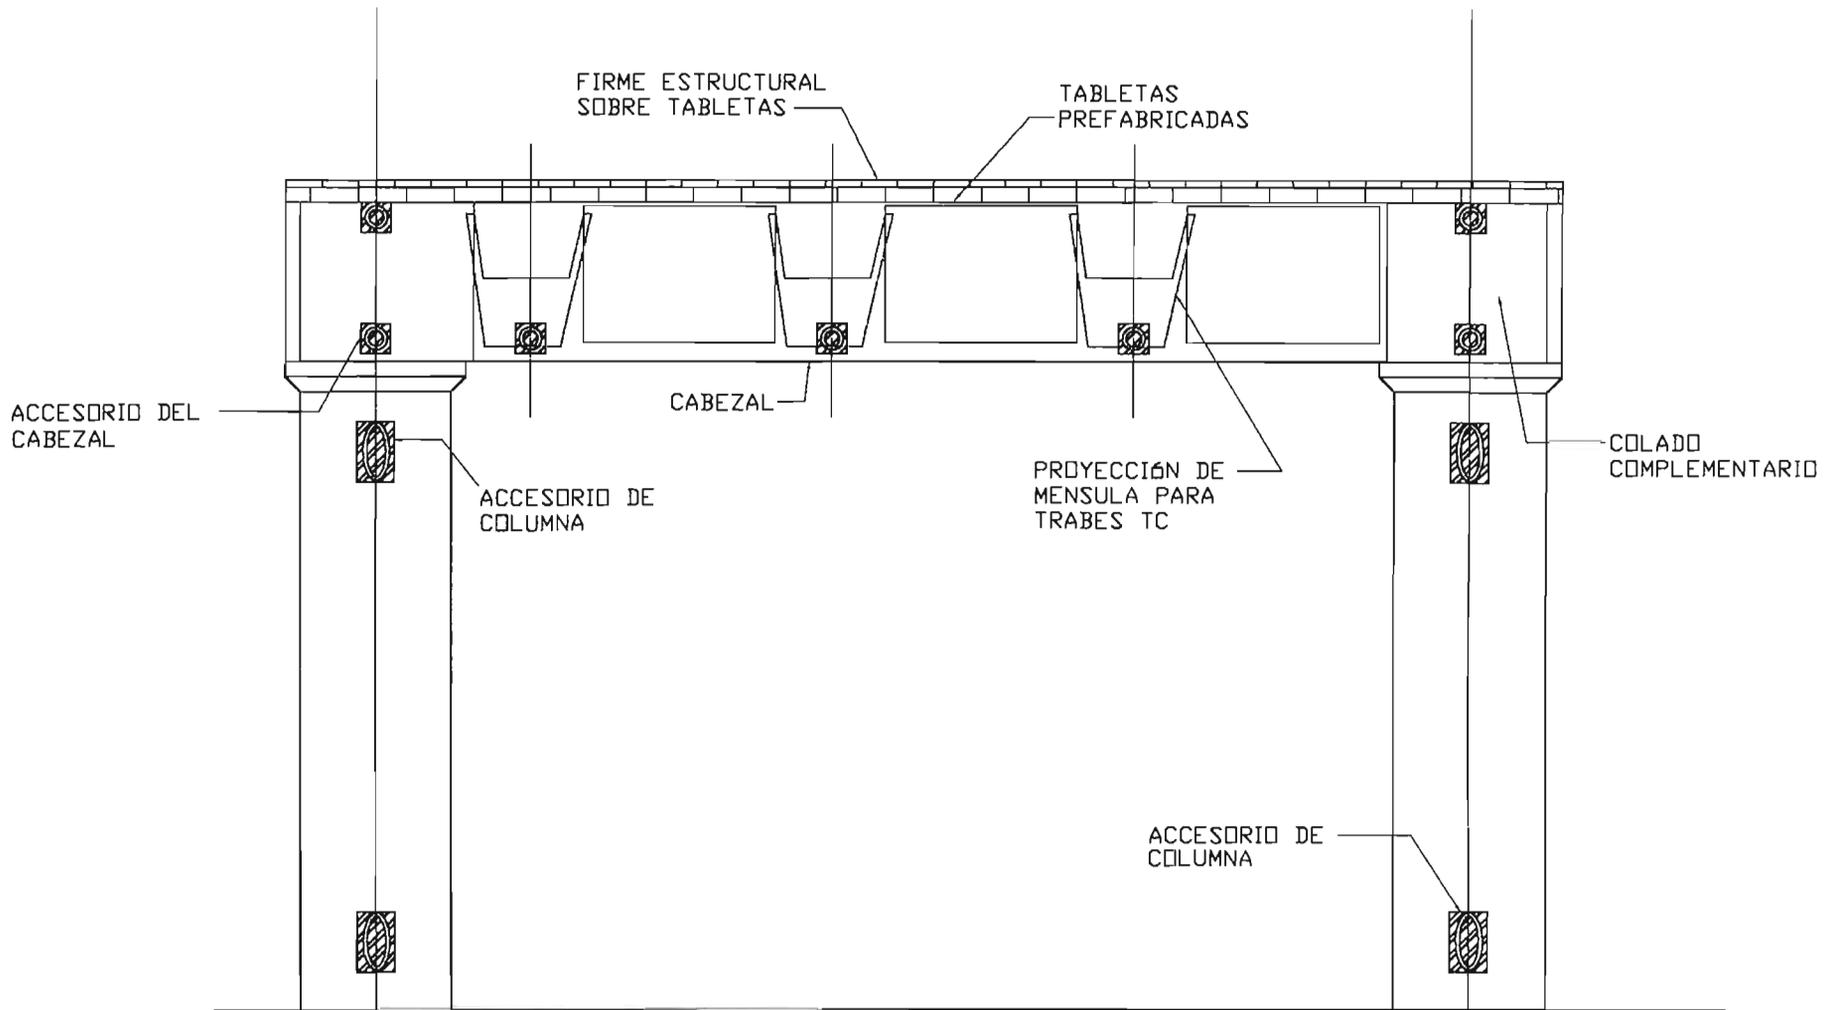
Contraventeo y apuntalamiento.
